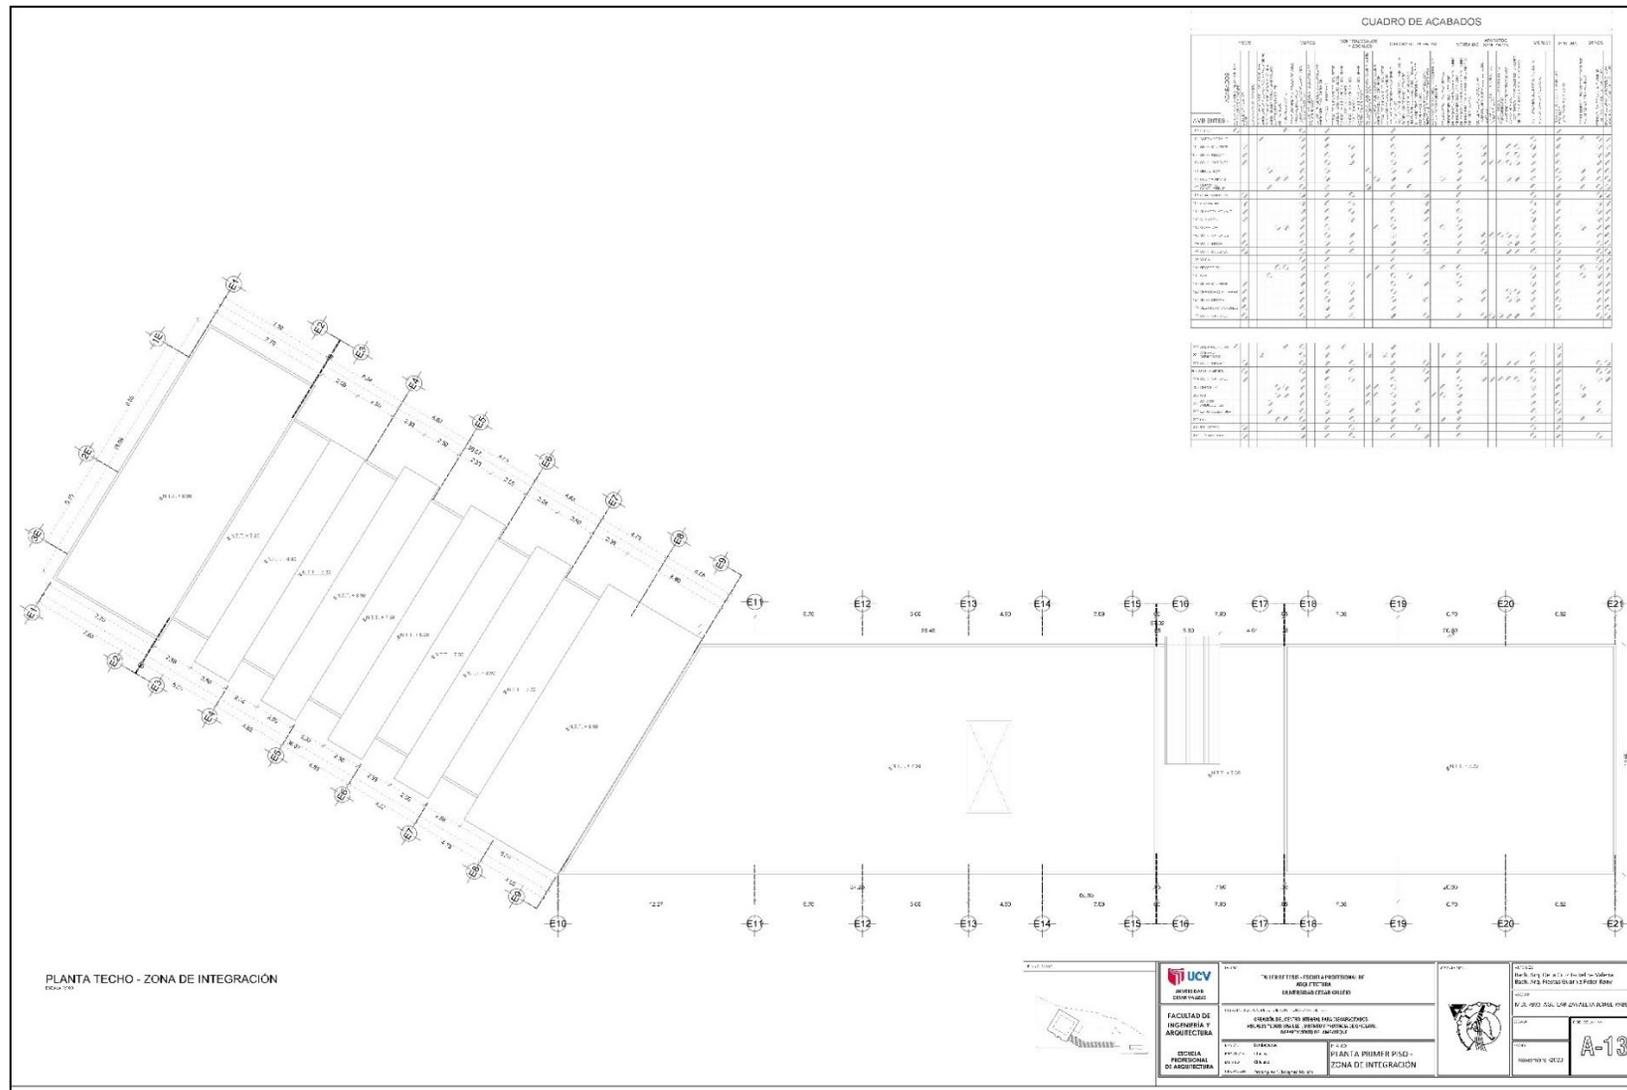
Planta techo-zona de integración. Fuente: Elaboración propia.
